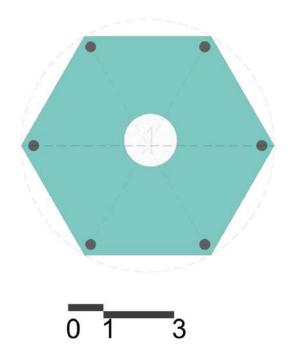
Planta 1 Bloque 46. Fuente: Equipo de diagnóstico.
